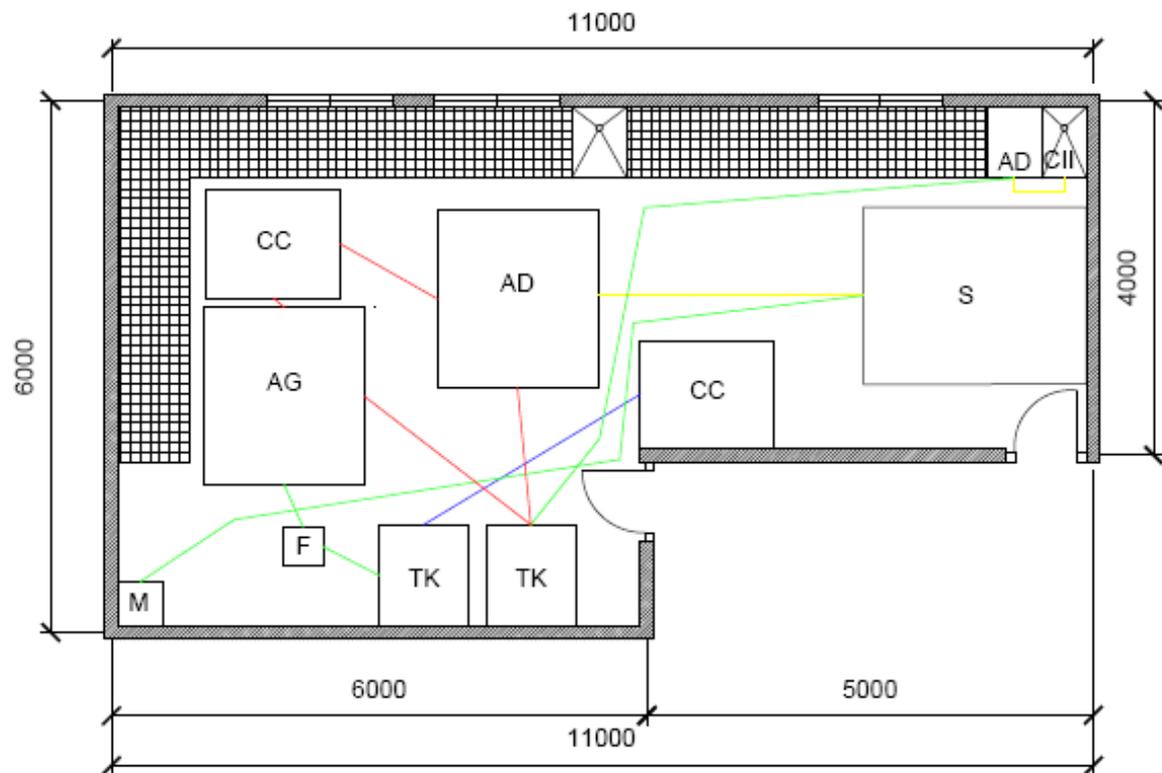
Variante 2 de distribución en planta. Fuente: Elaboración propia.
